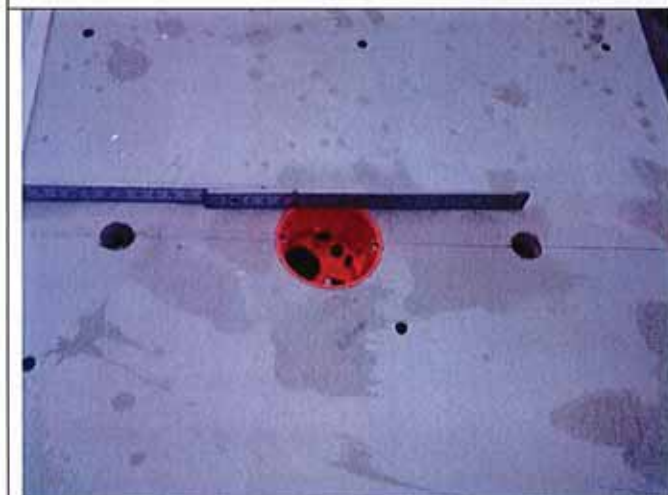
Aufbau. Einbau einer Hohlwanddose mit einem zusätzlichen Verschluss des Hohlraumes mit Pistolenschaum B1. Pistolenschaum B1 über die Hohlwanddose eingebracht. In Entfernung von 100 mm Kontrolllöcher eingebaut.
